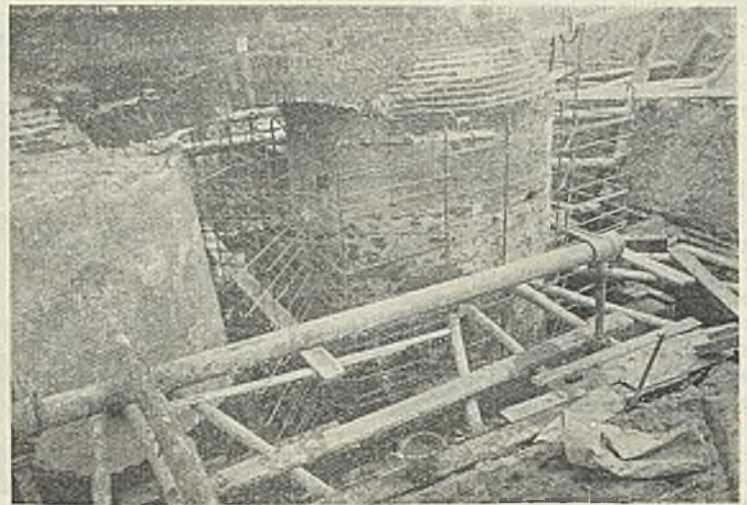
Alter Senkbrunnen mit Eisenbewehrung.
